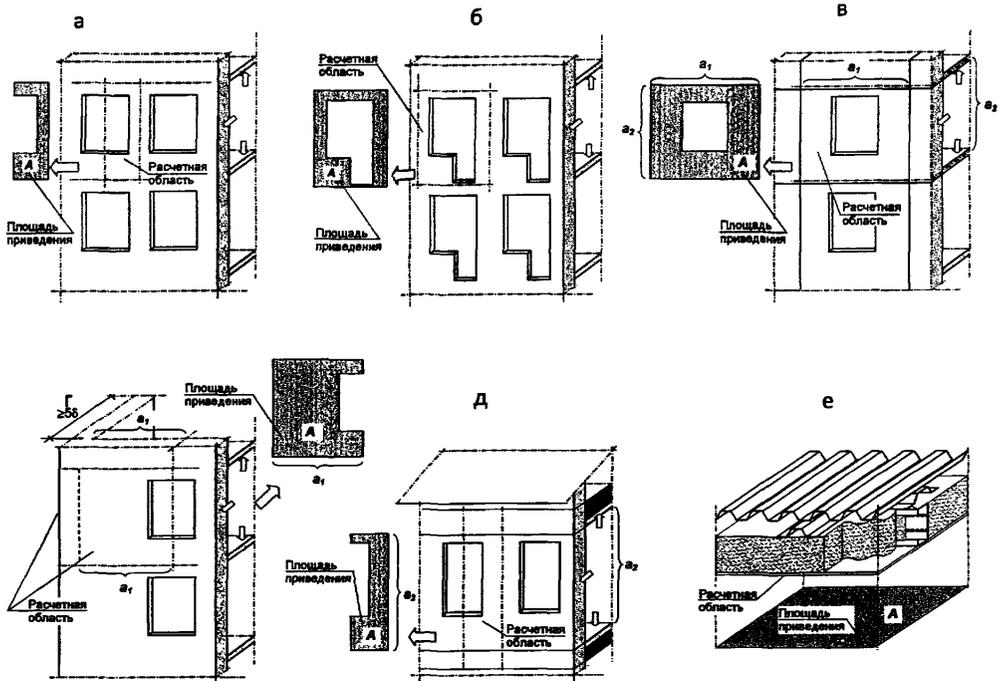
Примеры выбора расчетной области для некоторых типов конструкций: а – стена с окнами; б – стена с балконными дверями; в – стенная панель крупнопанельного здания; г – стена углового помещения; д – стена одноэтажного здания; е – совмещенное покрытие
